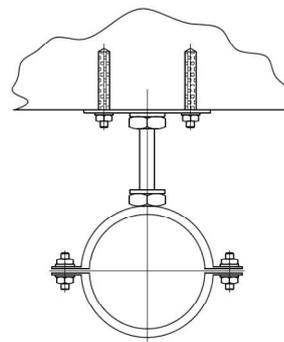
Крепление к перекрытию 2-мя анкерами забивными
